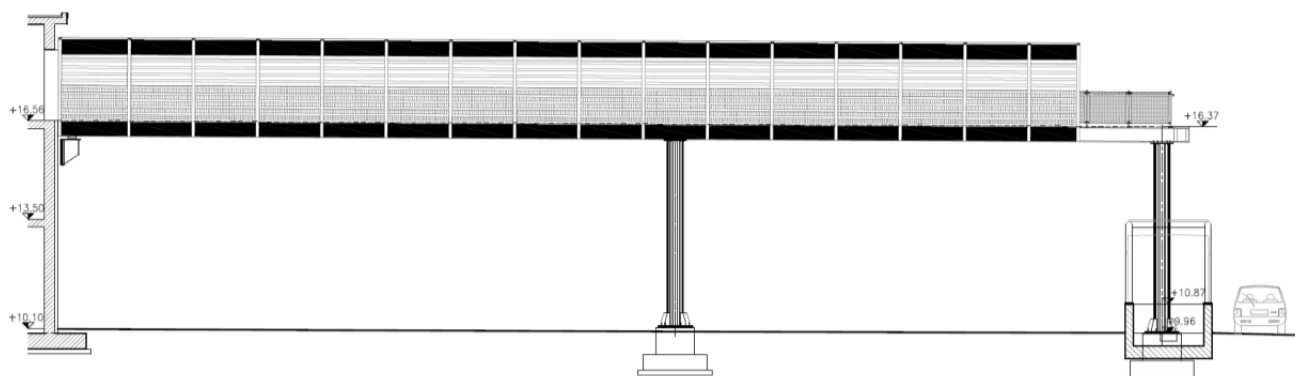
Prospetto della passerella pedonale (estratto dalla tavola I.01.08.0.0).
